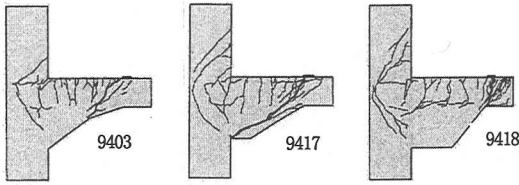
TYPE-II ②試験体のひび割れ発生状況
